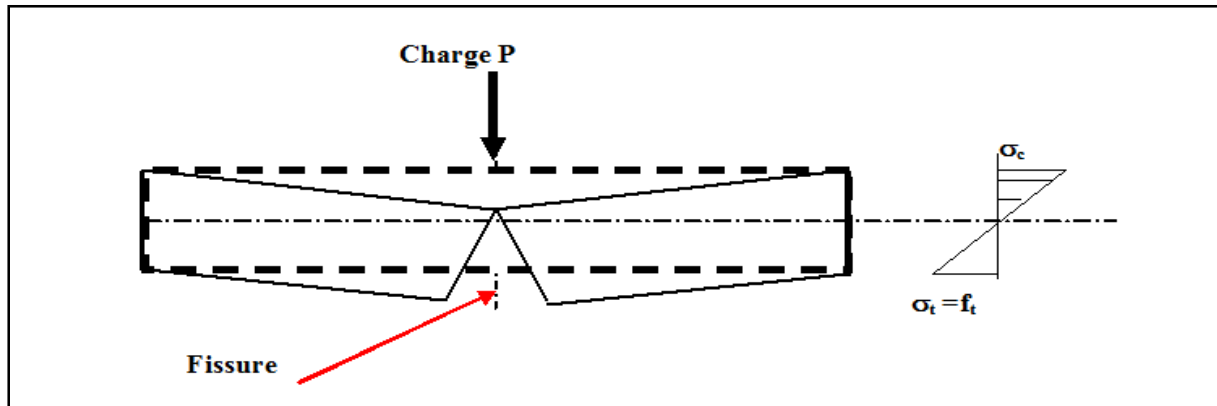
Mécanisme de ruine d'une poutre en béton sans armatures
